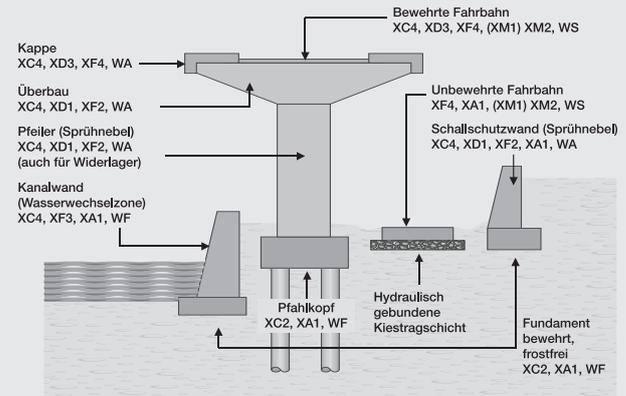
c: Betonbauteile im Ingenieurbau
